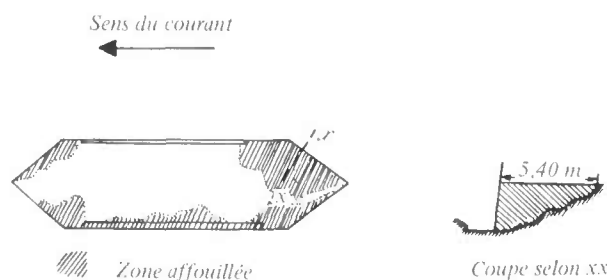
Affouillement d'une fondation sur tuf. Vieux pont de Toulouse (d'après Séjourné).
